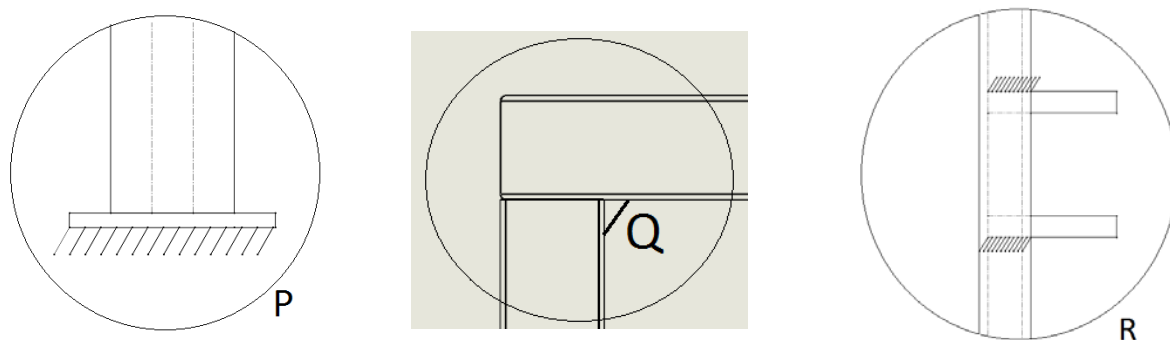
Esquema detallado de la estructura aporricada tipo puente grúa
